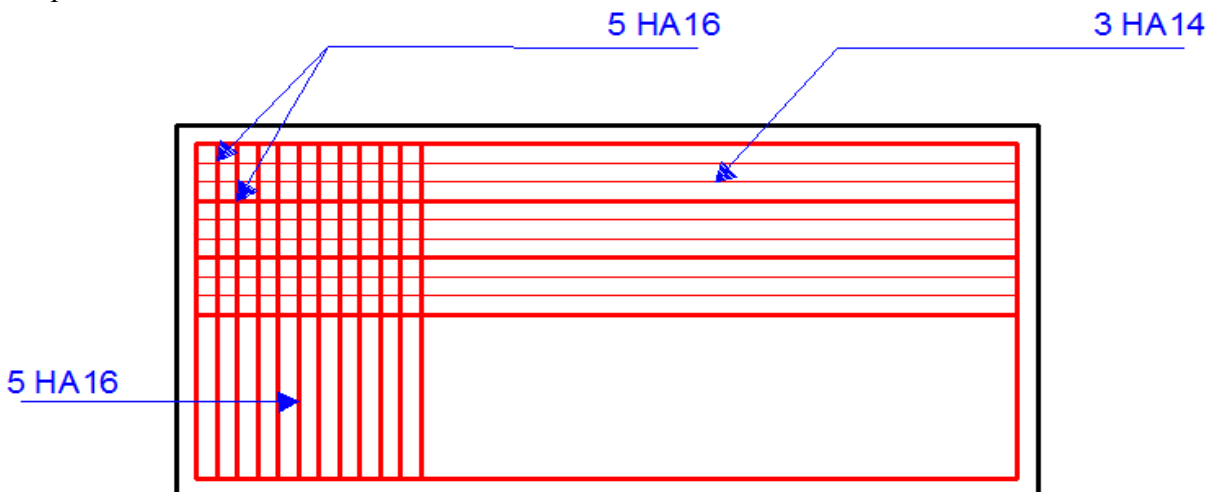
Schéma de ferrailage (nappe supérieure)
